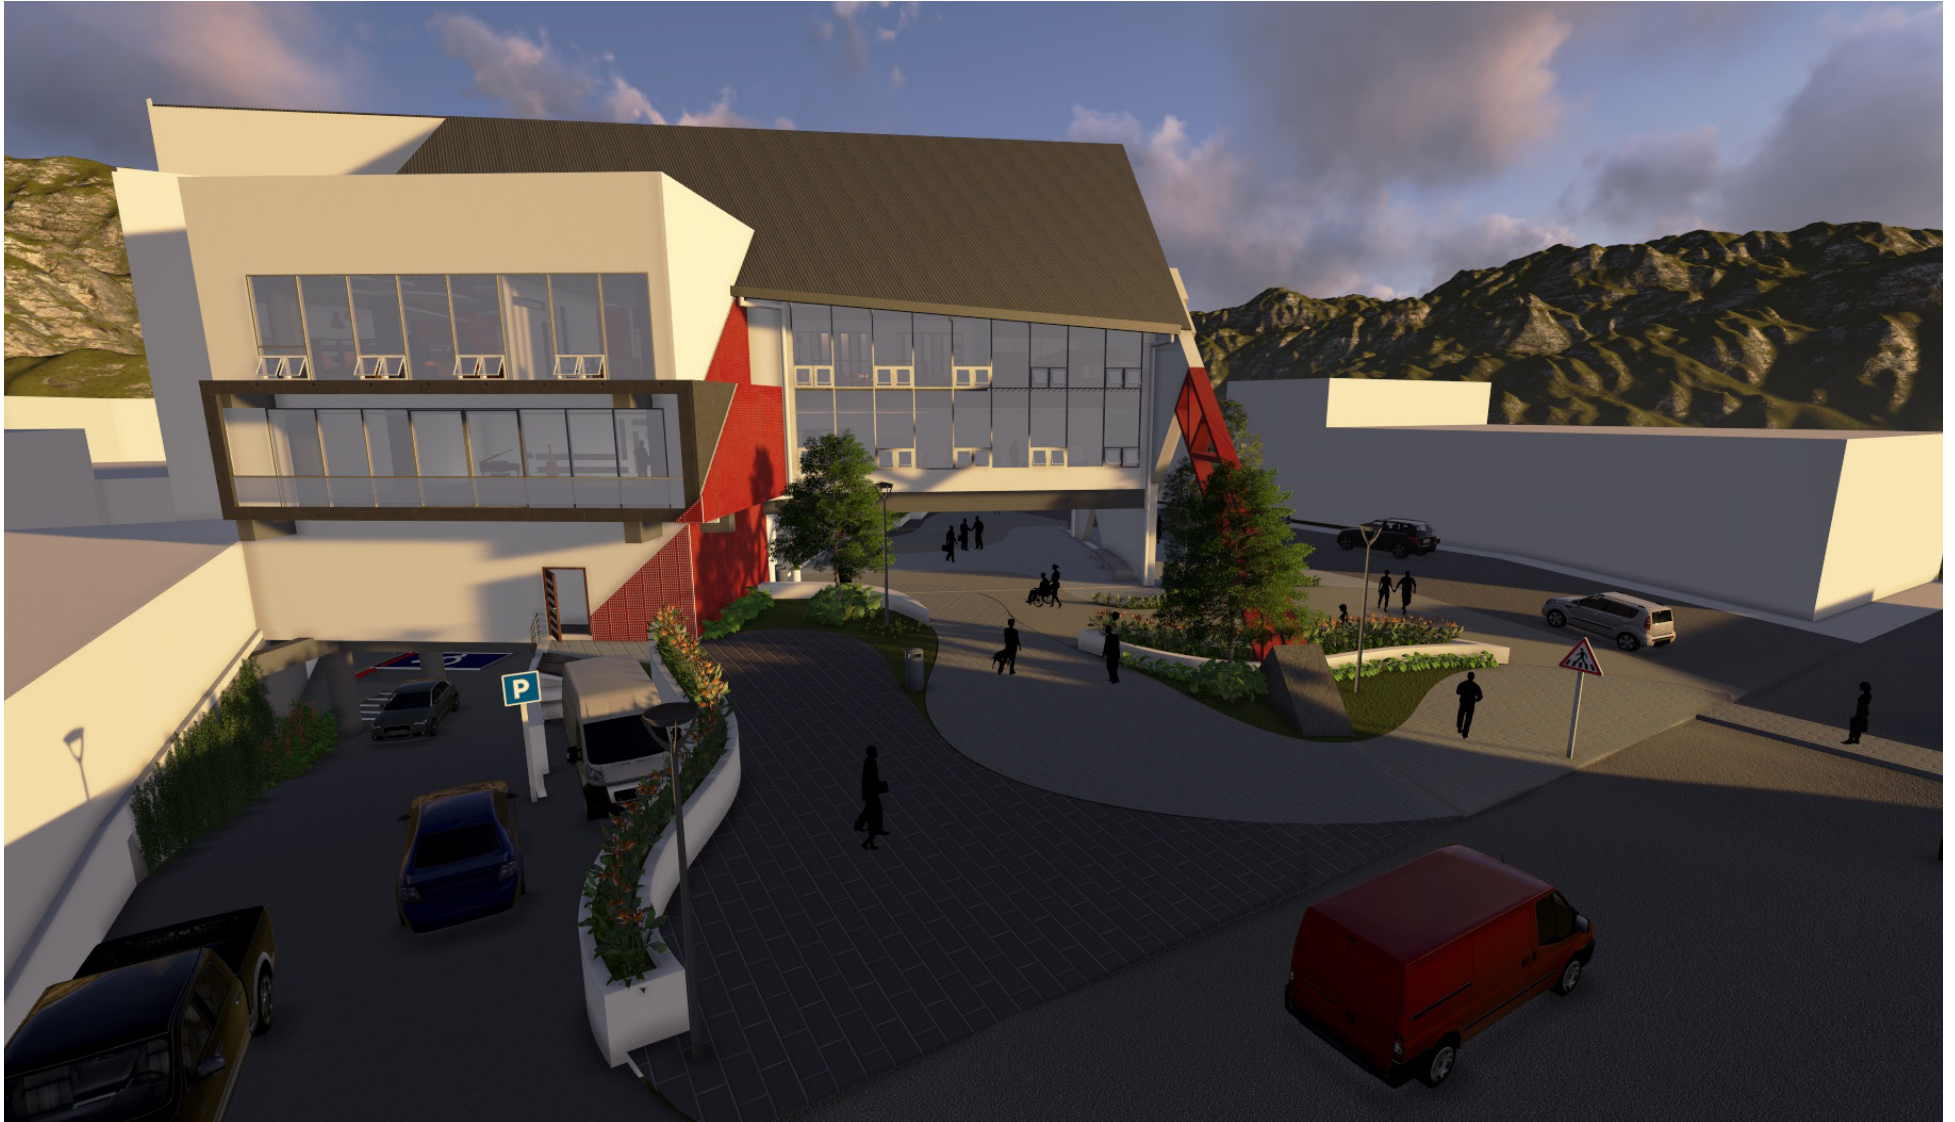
Vista Plaza E Ingresos. Fuente: propia
